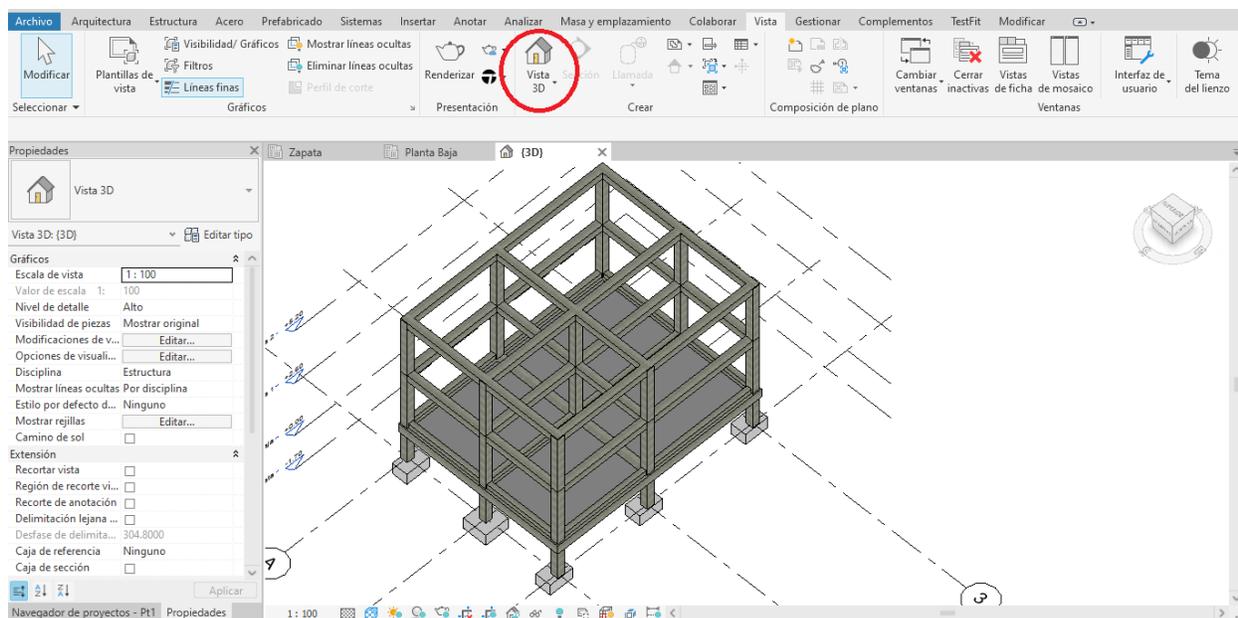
Vista 3D creación de losa maciza en la planta baja.
